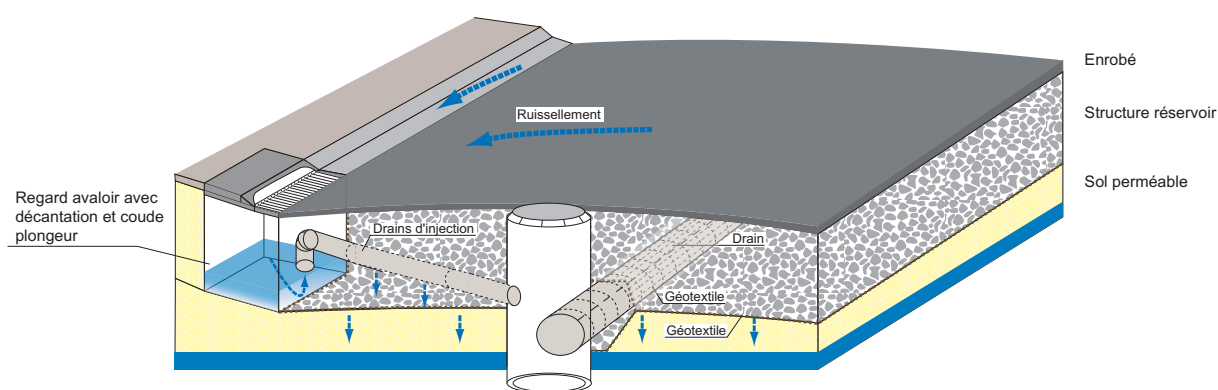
Coupe en travers type d'une chaussée à structure réservoir.
